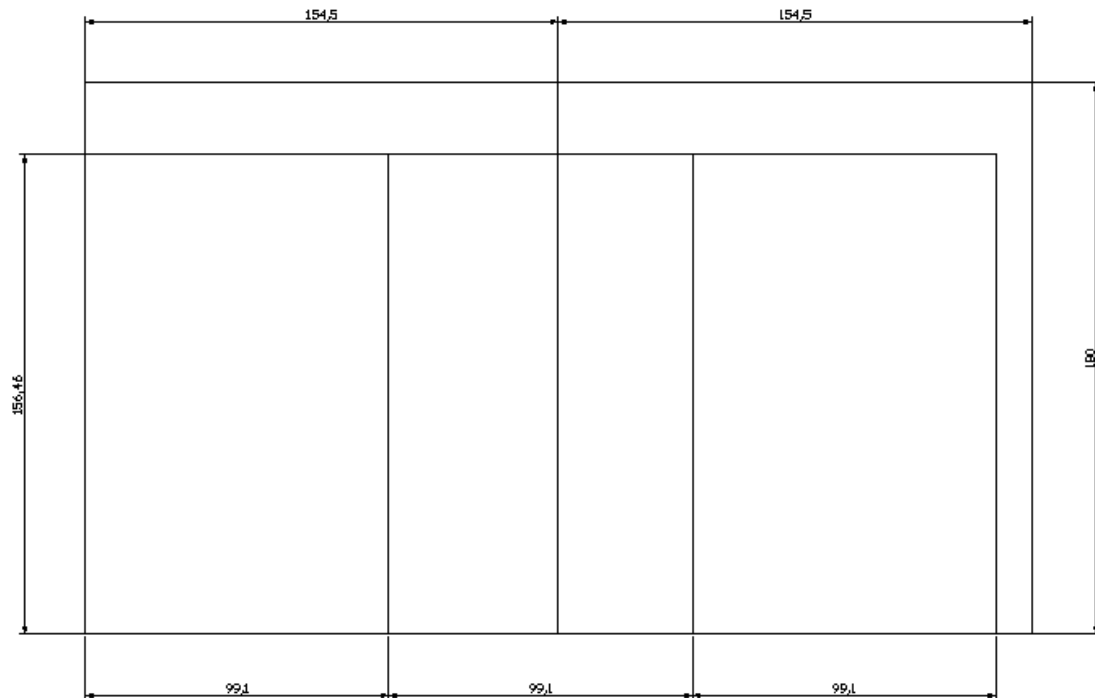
Planta de la estructura de módulos con los 3 módulos
